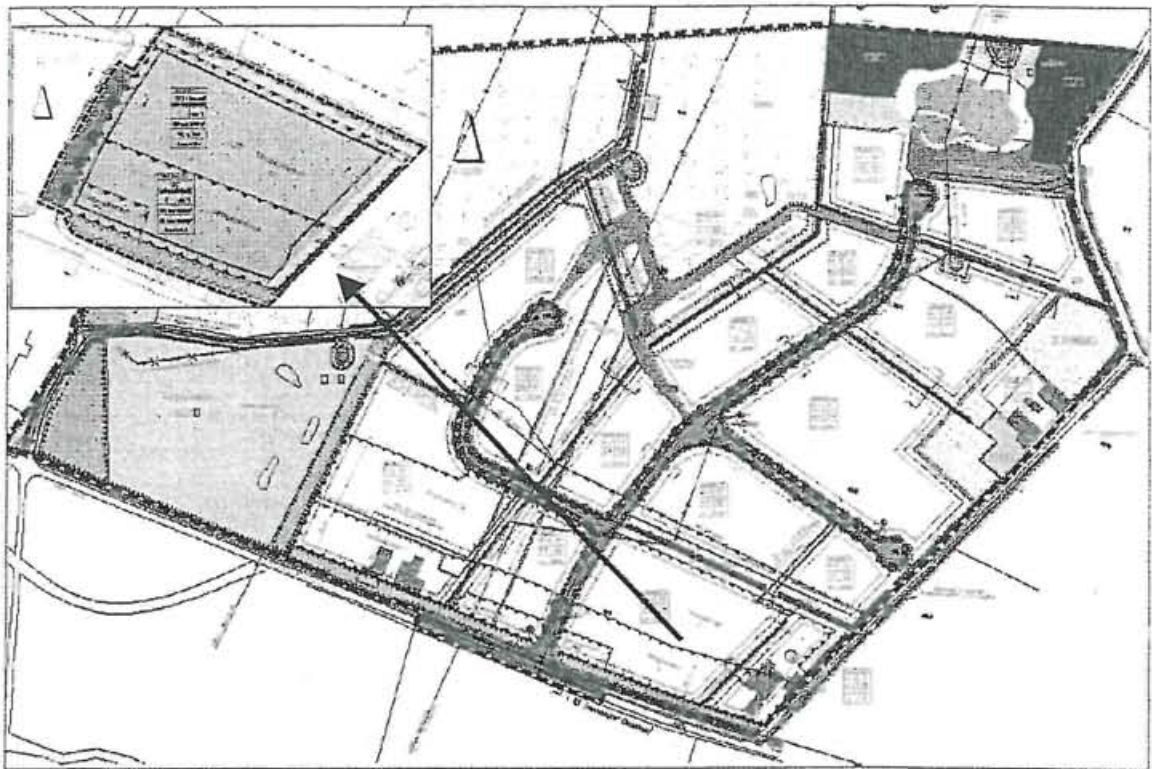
Entwurf Bebauungsplan Nr. 5c-2. Änderung [1]
